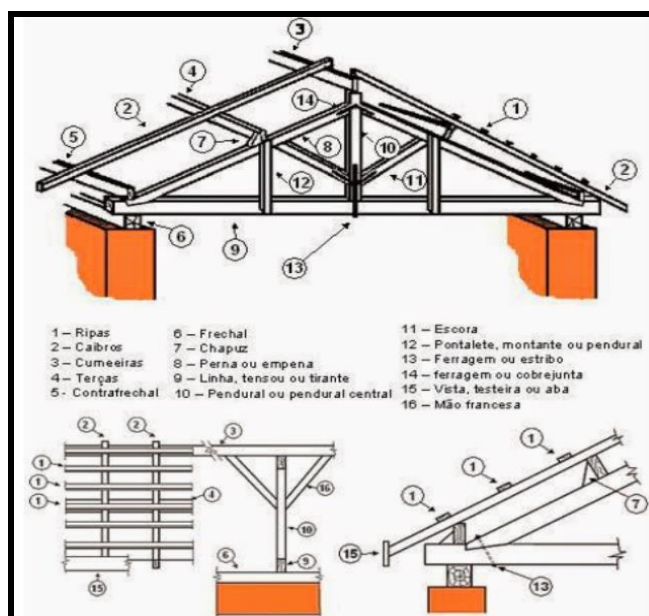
Ilustrativa – Tipo – Madeiramento em Tesouras
